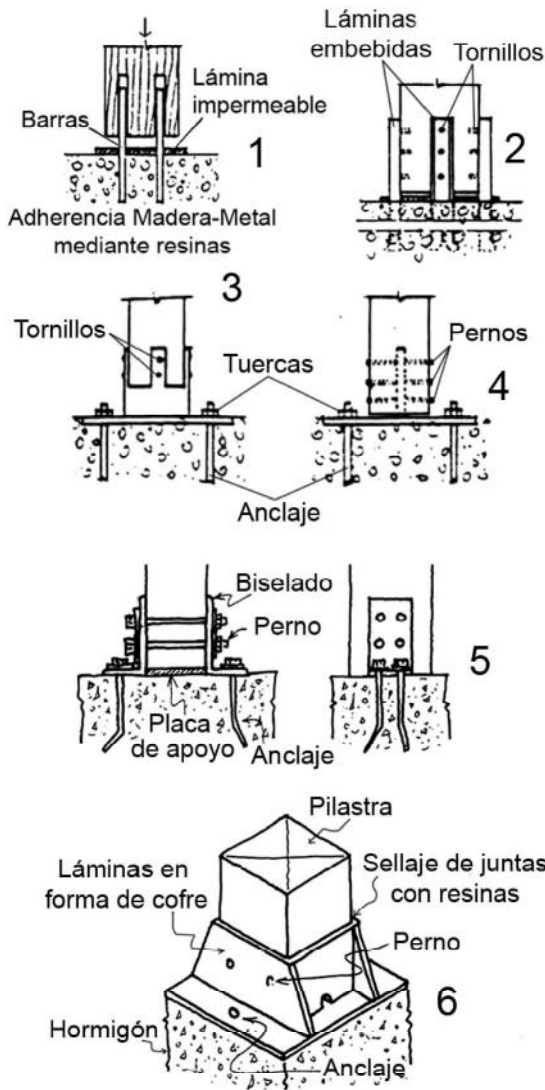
Tipos de unión Columna-Pedestal o Columna-Cimiento.
